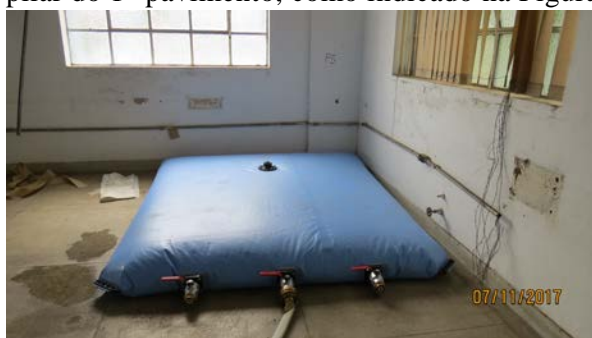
Ala Sul – Ensaio no Pilar P5.
